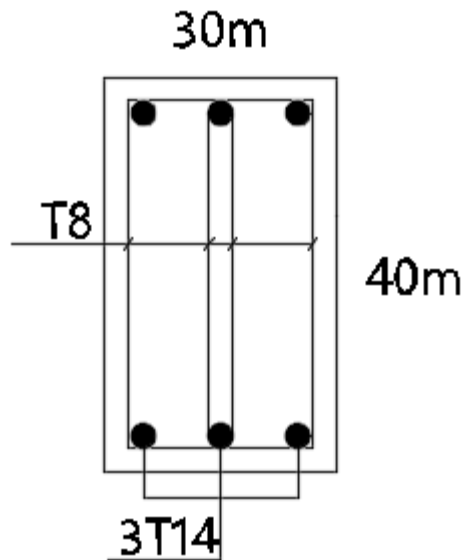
Schéma de ferrailage de la poutre brisée.
